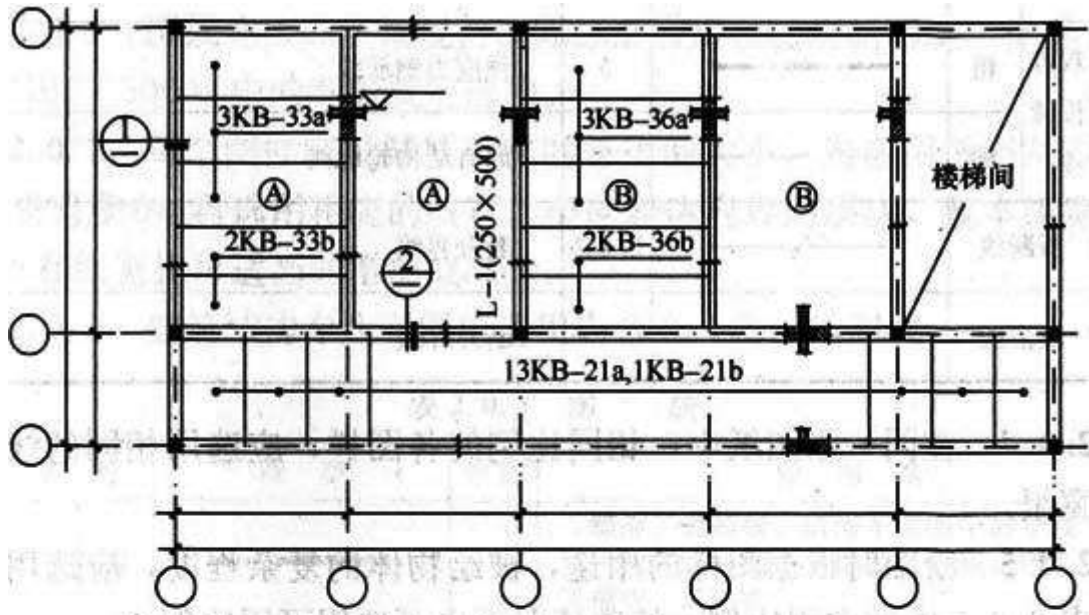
用正投影法绘制预制楼板结构平面图
